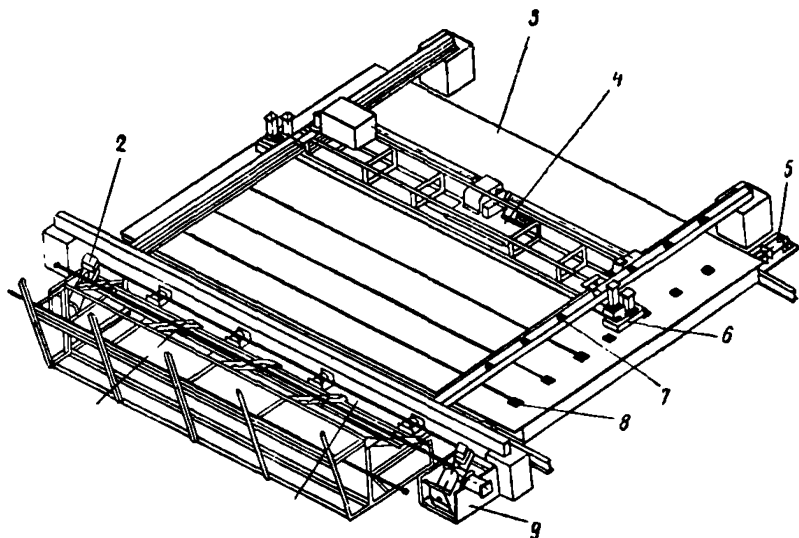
Установка для нагрева и укладки горячих стержней в упоры формы-вагонетки
